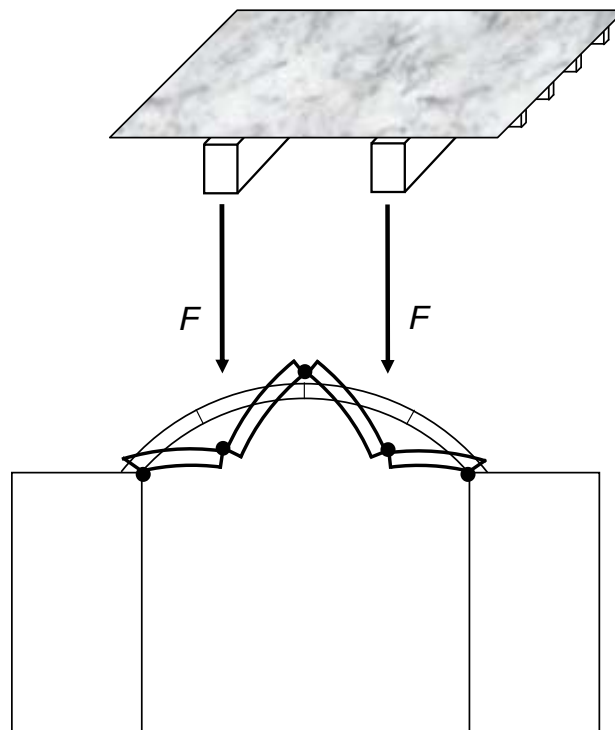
b*. I piedritti massicci collocano a un livello gerarchico elevato il meccanismo per apertura delle imposte della volta (l'eventuale catena lo interdice).
